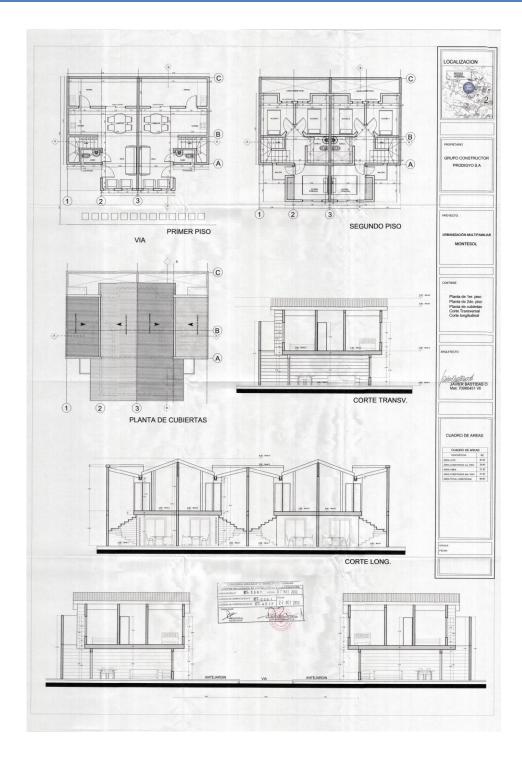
Planta de cubierta y cortes transversal y longitudinal de las viviendas.
